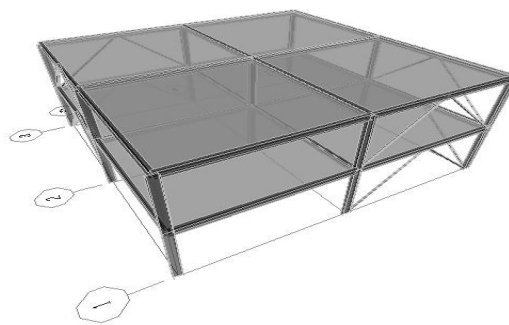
Exemple d'ossature comportant des planchers rigides dans leurs plans ou diaphragmes
